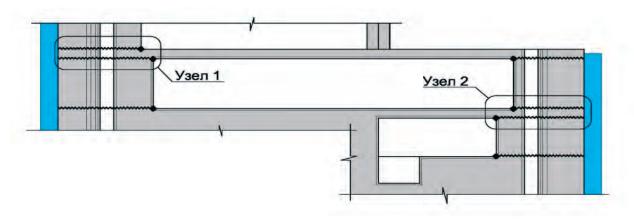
Гидроизоляция стыков стен и перекрытий в машинном зале и технологических помещениях здания ГЭС (фрагмент 1 на рис. 6.1.1)
